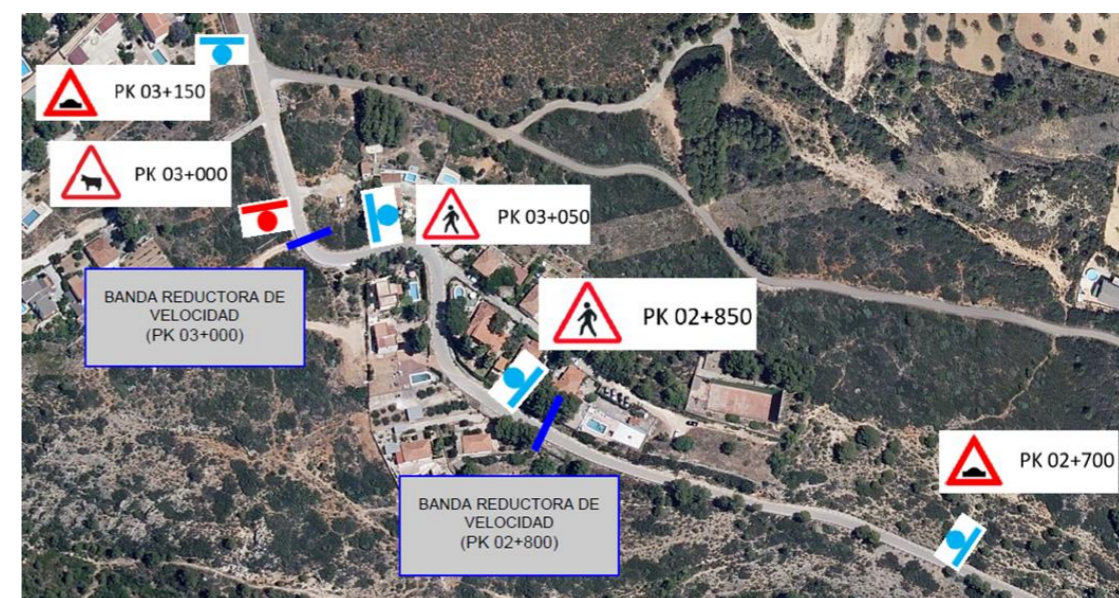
Recorte de la vista en planta de la disposición de mejora de señalización entre los PK 02+700 Y 03+150. (Fuente: Elaboración propia).
